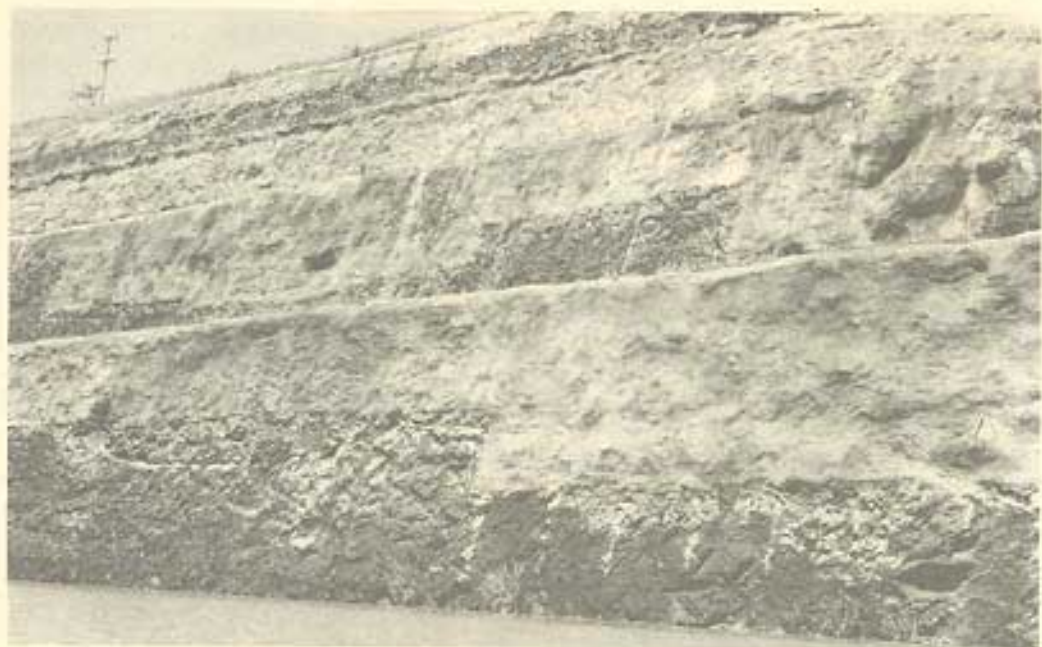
Concreto projetado aplicado como proteção definitiva
